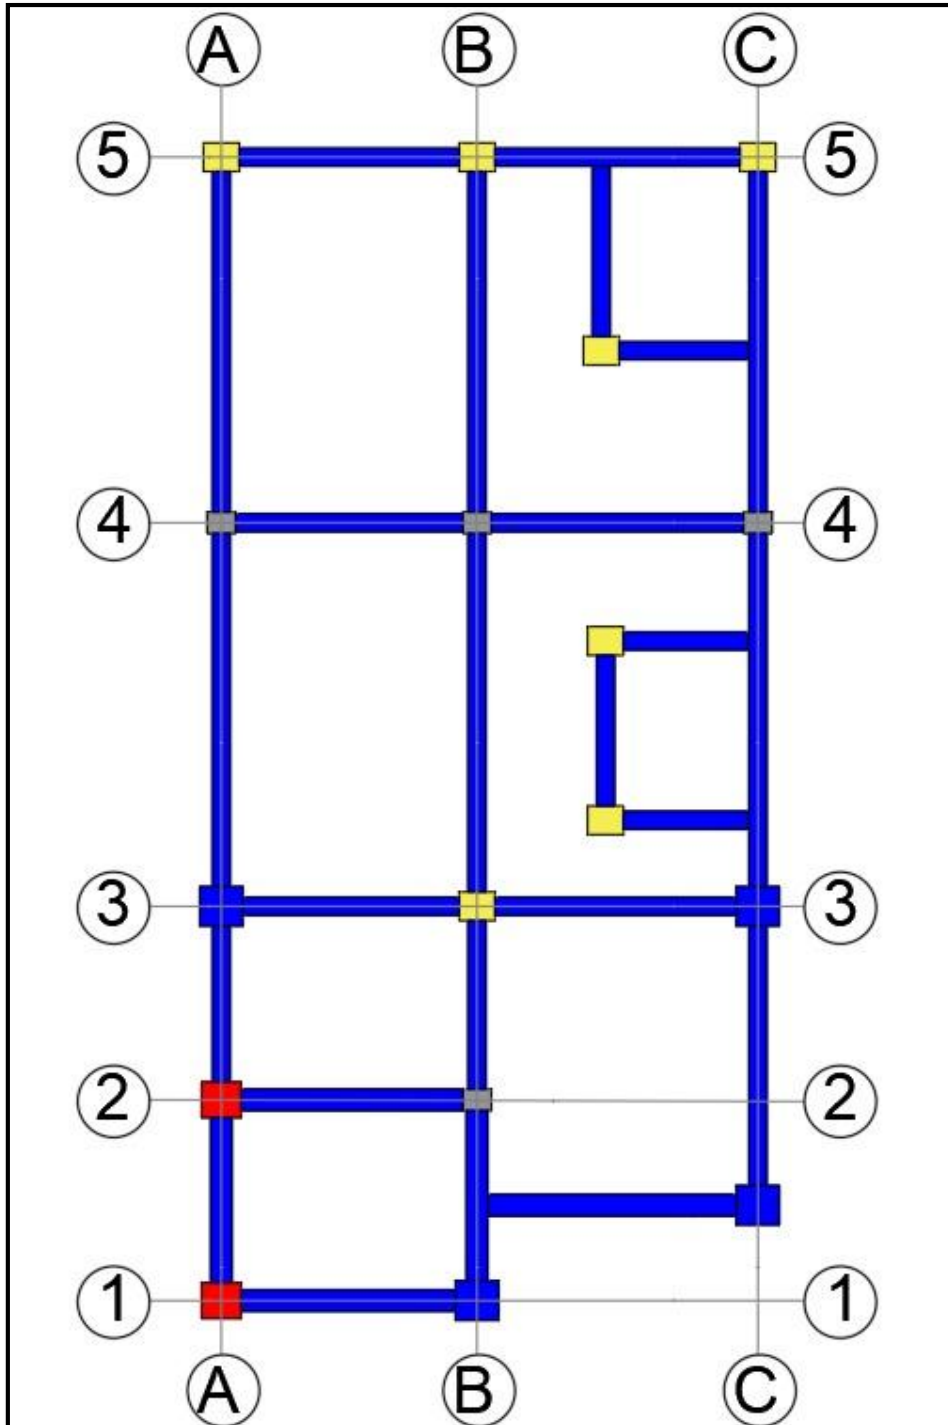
Distribución de vigas y columnas piso 1. Fuente: Nicolás Pozo
